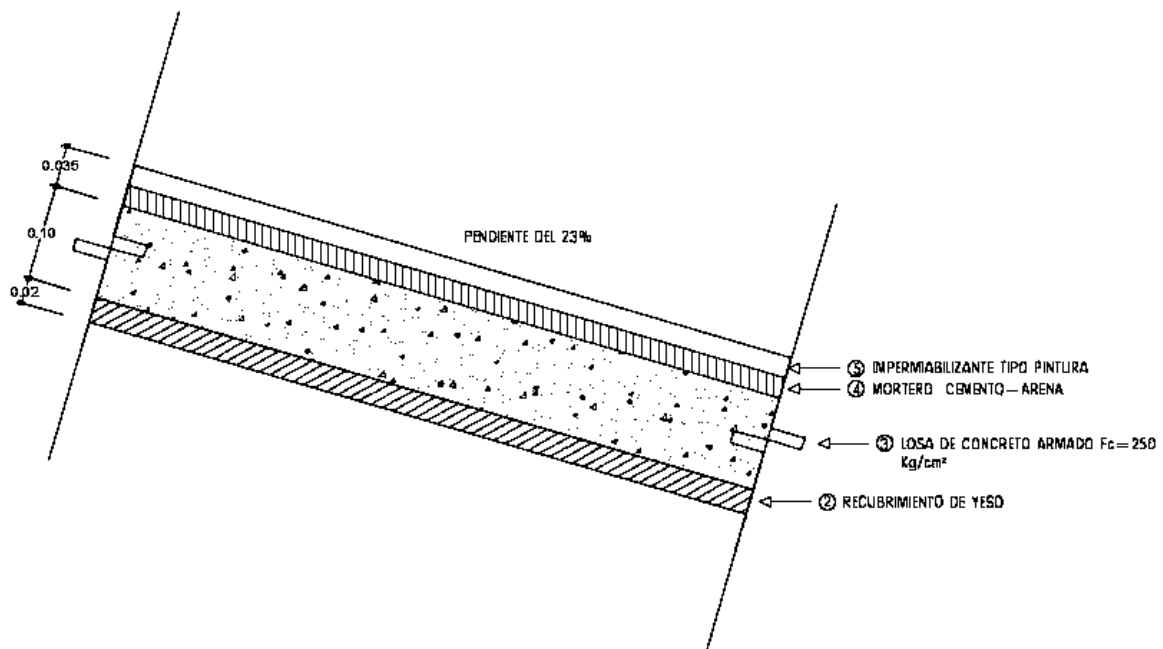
detalles de los espesores de la losa horizontal de azotea con una pendiente del 23%.
